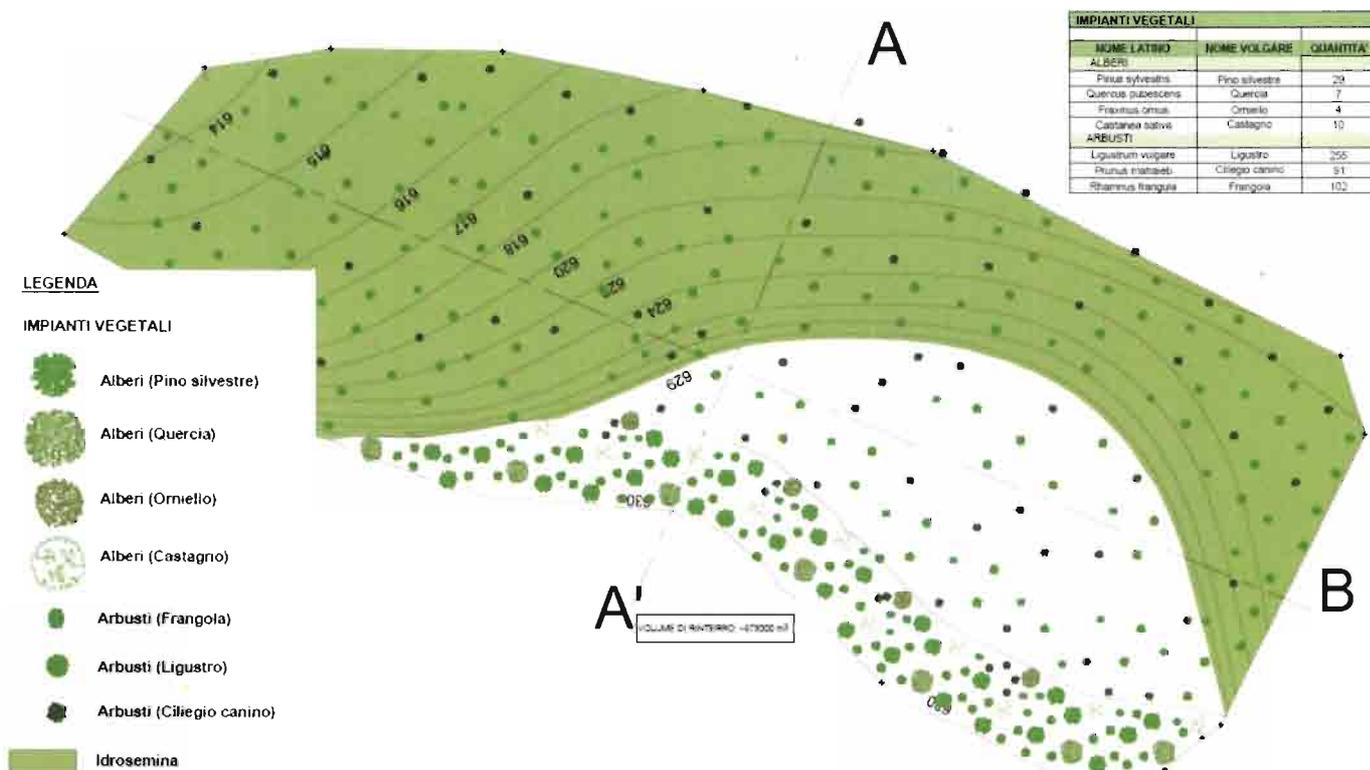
Planimetria delle opere a verde in corrispondenza del deposito definitivo Plaikner.
